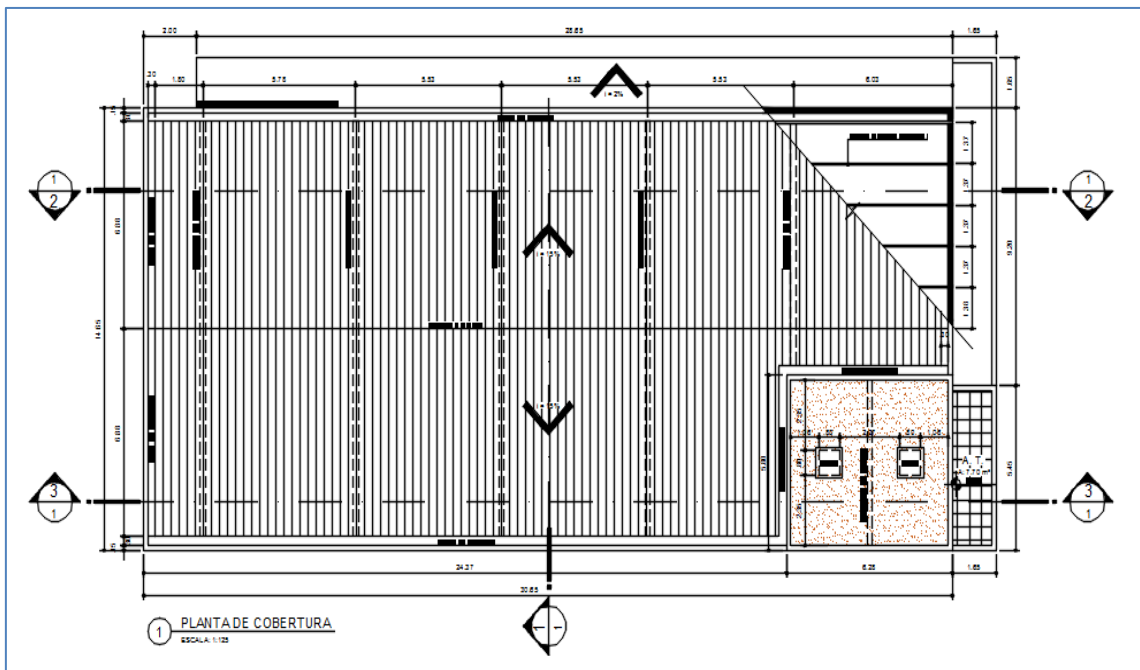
Planta baixa: cobertura (autor do projeto arquitetônico)
